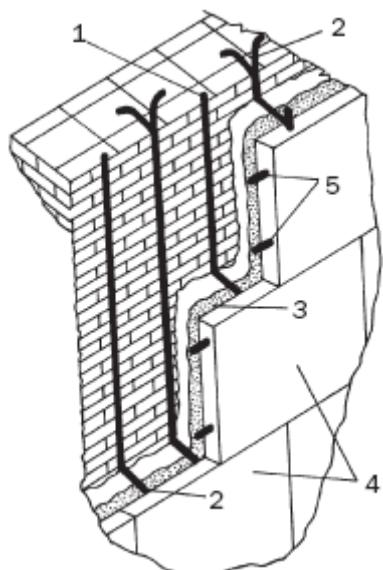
Крепление плит стержнями, петлями и штырями: 1 – опорный стержень; 2 – петли; 3 – раствор; 4 – плиты облицовки; 5 – штыри
